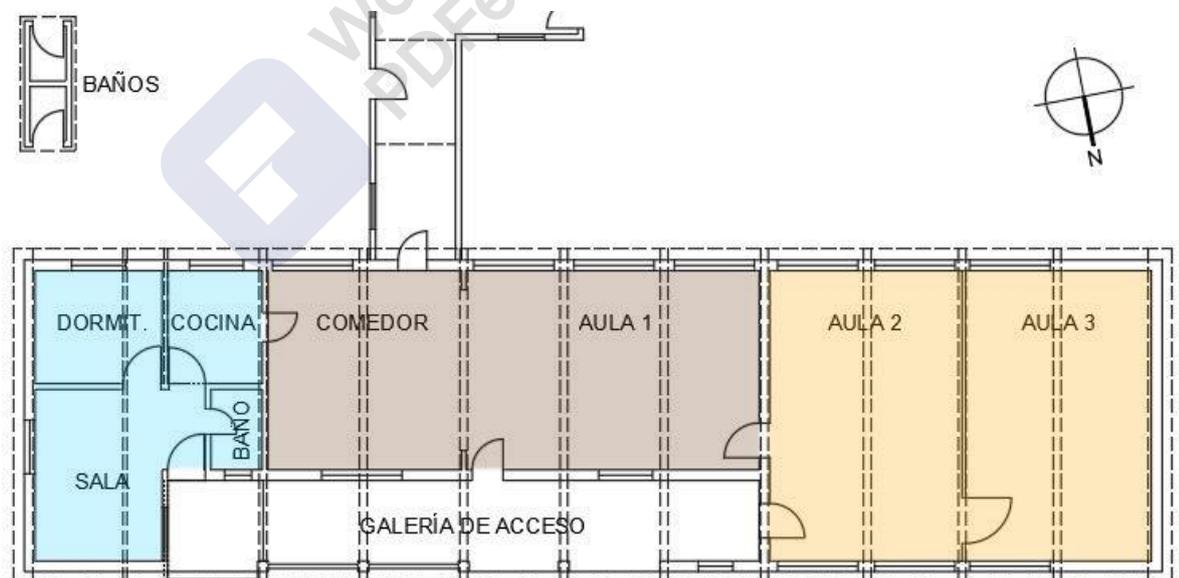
Planta Escuela rural 30 con división de bloques para modelado.
